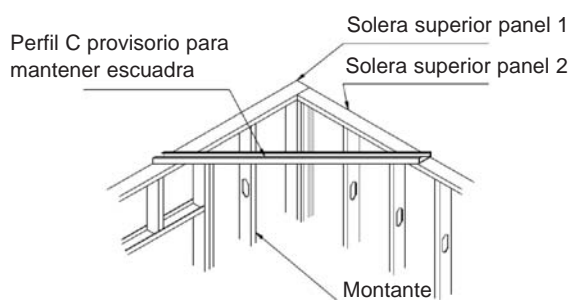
Fijación de perfil C para mantener la escuadra de los paneles (Adaptado de ConsulSteel, 2002)
